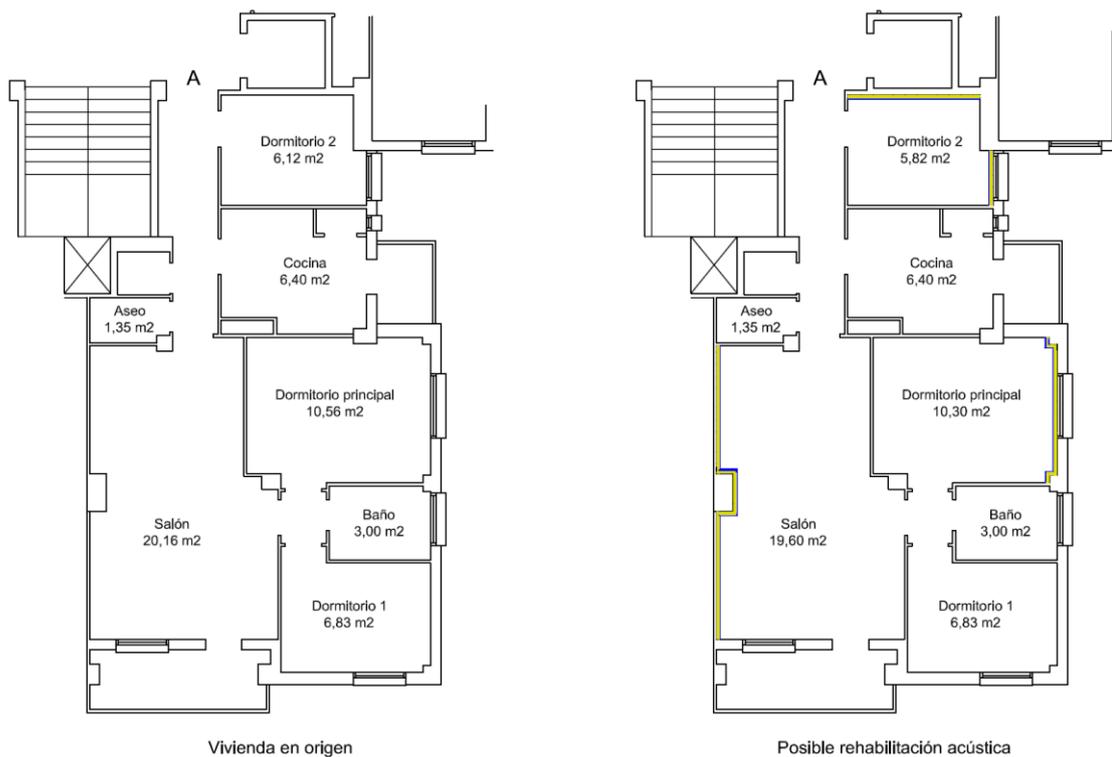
Plano viviendas de las torres del Conjunto Balsas de Ebro Viejo, Zaragoza.
